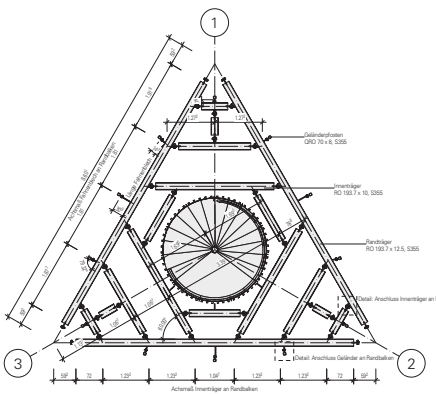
Grundriss Unterkonstruktion für die Aussichtsplattform. Die Balkenlage aus Rundstahlprofilen ist in die drei Hauptrichtungen gleichartig konstruiert. (Zeichnung: Ingenieurbüro Miebach)
